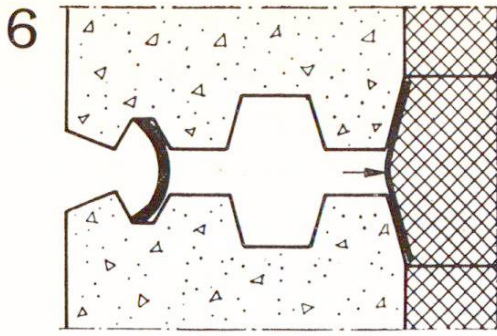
Joint vertical à double étanchéité. L'étanchéité contre la pluie est assurée par une bande de métal ou de matière plastique placée contre un épaulement un peu en retrait de la surface. On a ainsi l'impression qu'il s'agit d'un joint ouvert. L'étanchéité au vent est réalisée par une feuille de plastique au fond du joint.
